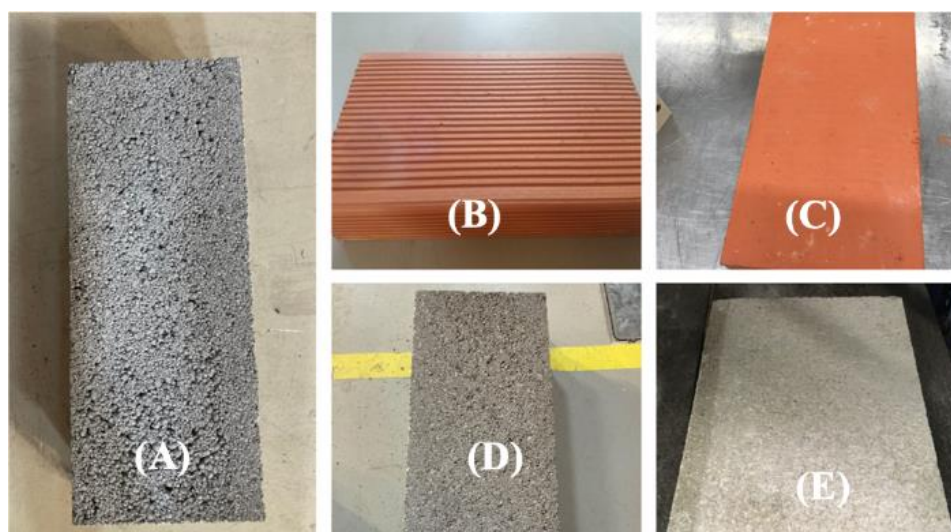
Substratos utilizados - (A) Bloco de betão leve; (B) Tijolo cerâmico furado; (C) Tijolo cerâmico maciço; (D) Bloco de betão; (E) Placa de betão.
